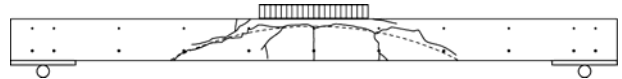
ひび割れ状況図(供試体 N 試験後)
